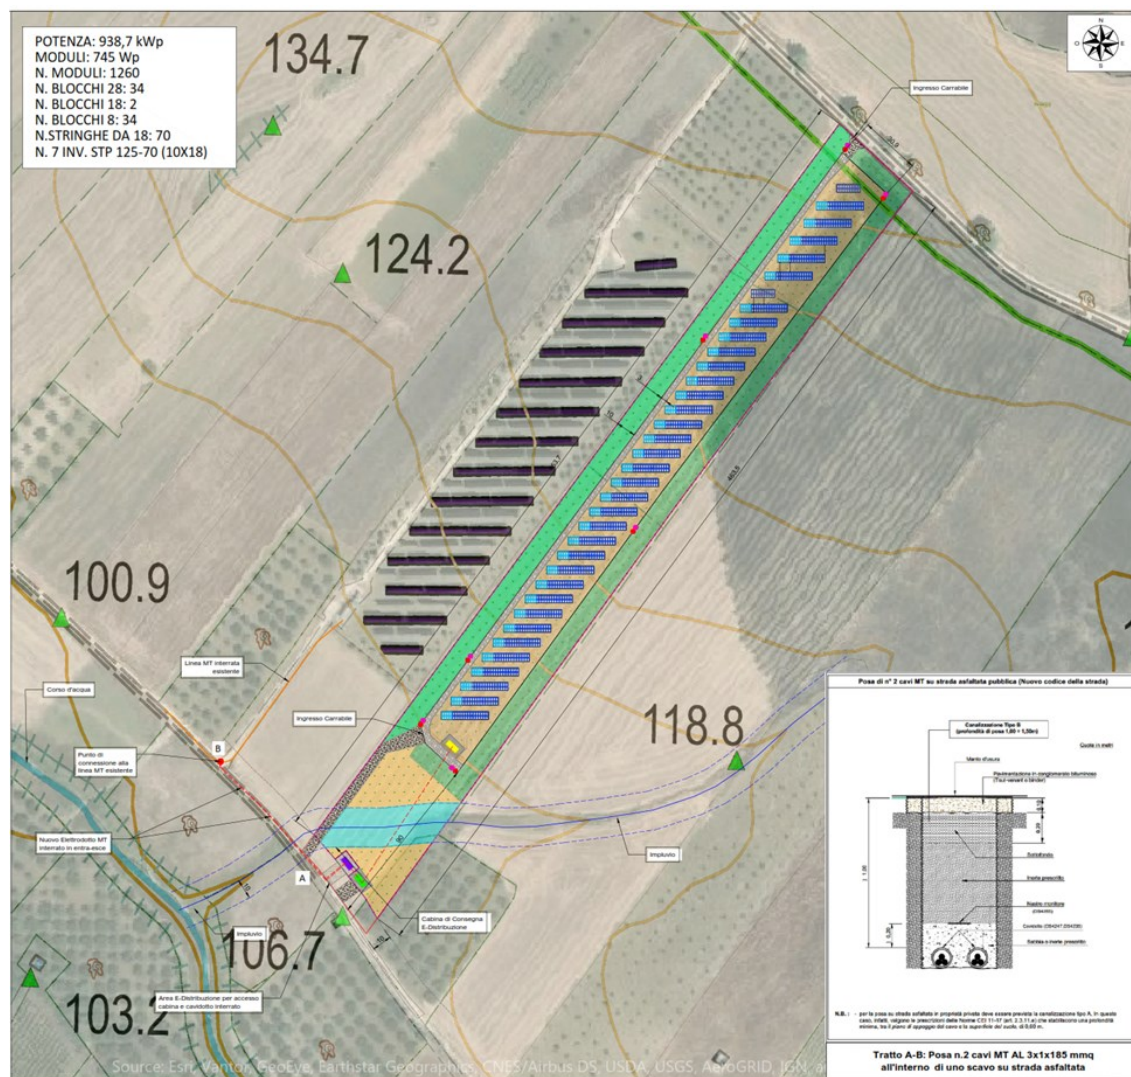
Stralcio Layout di impianto su CTR e ortofoto
